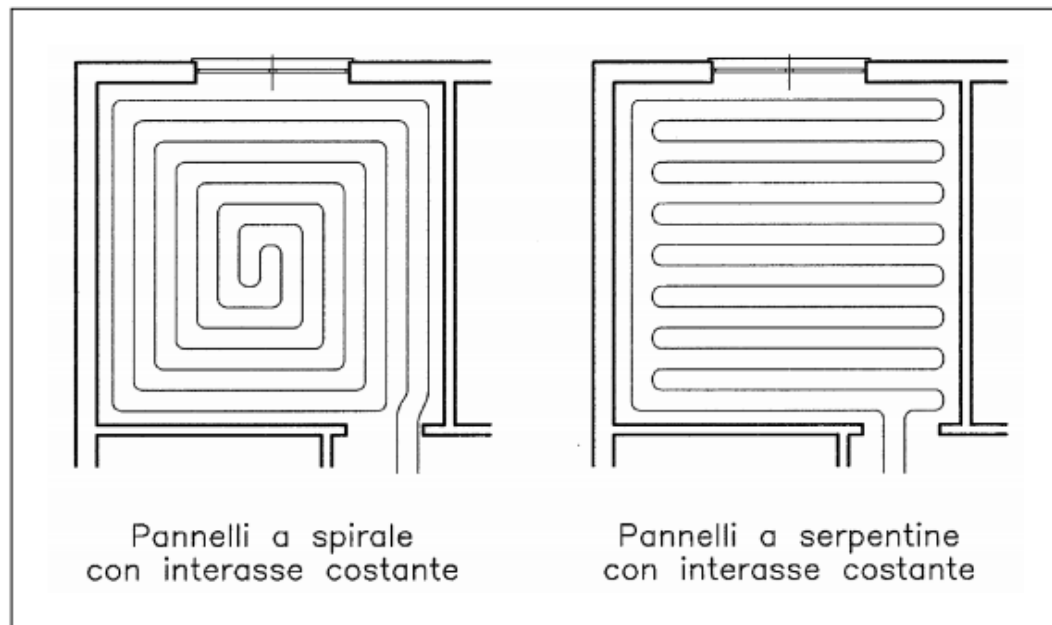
Disposizione di pannelli radianti a spirale (sinistra) e a serpentina (destra) [14].
